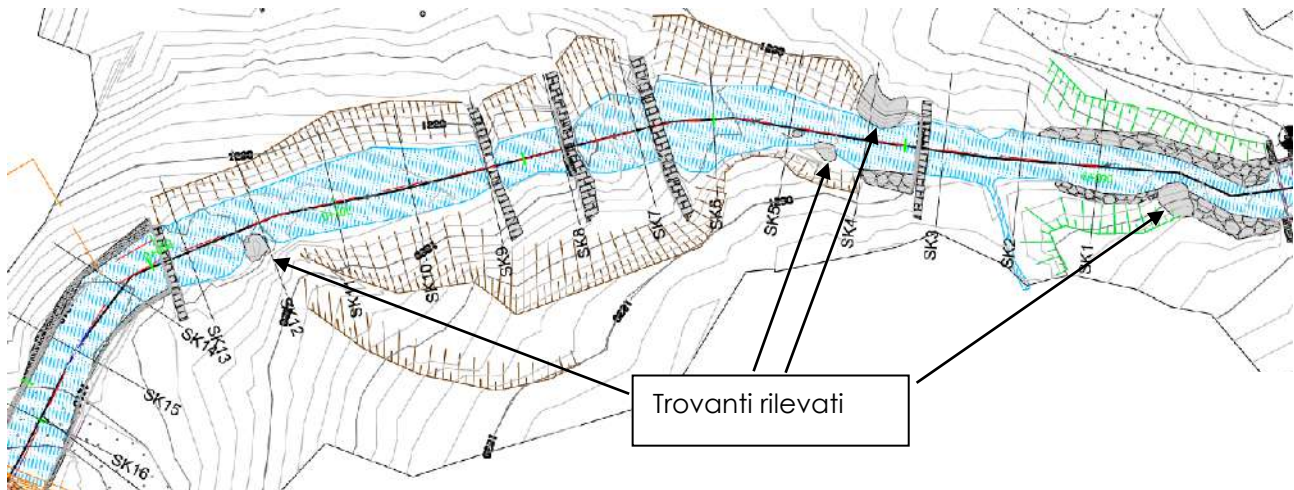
Trovanti rilevati a monte dell'attraversamento della SS 51 sul t. Bigontina (Elaborato 4.5)
